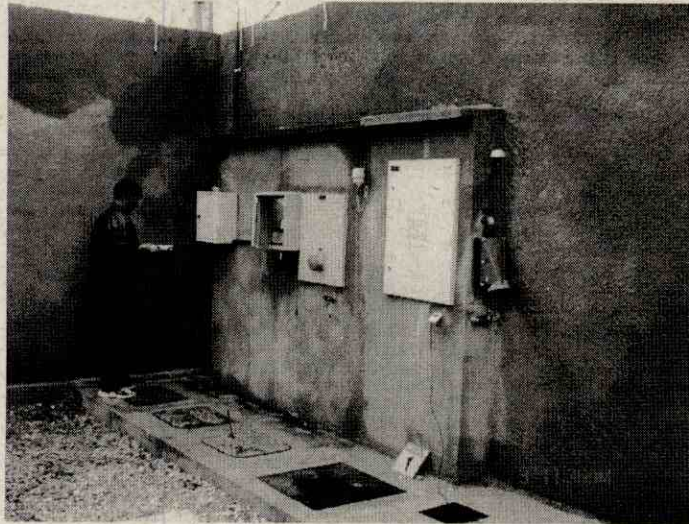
Alvenaria de fechamento do Site sobre viga Baldrame.
